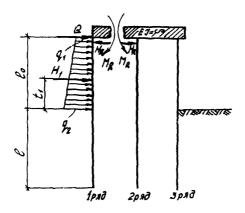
Схема и расчету подпорной стены при многорядном расположении свай.
